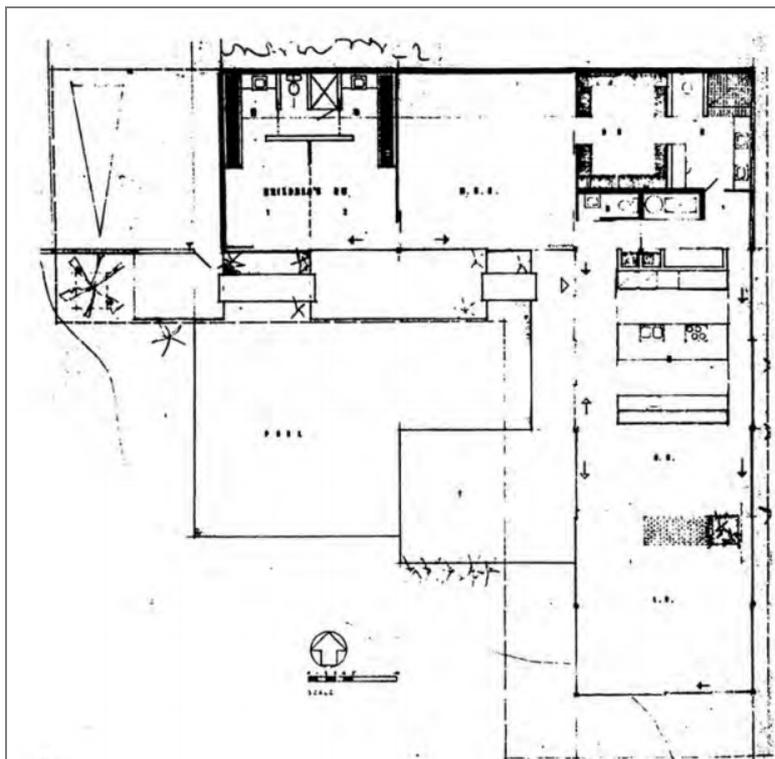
Planta baixa com formato de L, com destaque para a piscina. Fonte: Murtinho e Goncalves (2014)
